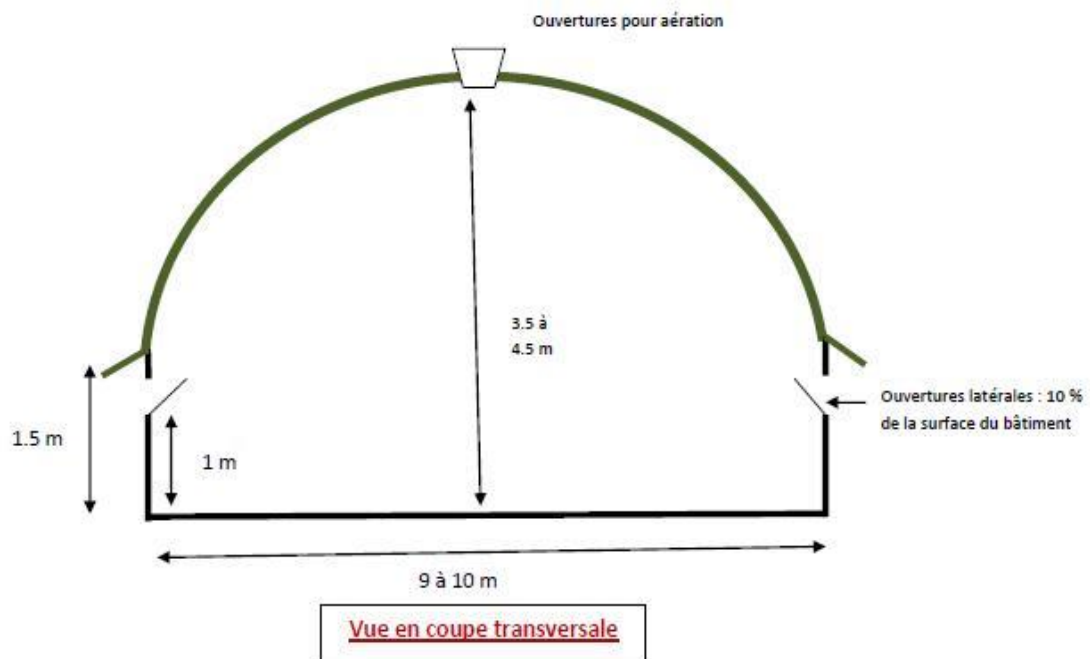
Plan d'un bâtiment type tunnel de 500 m²
